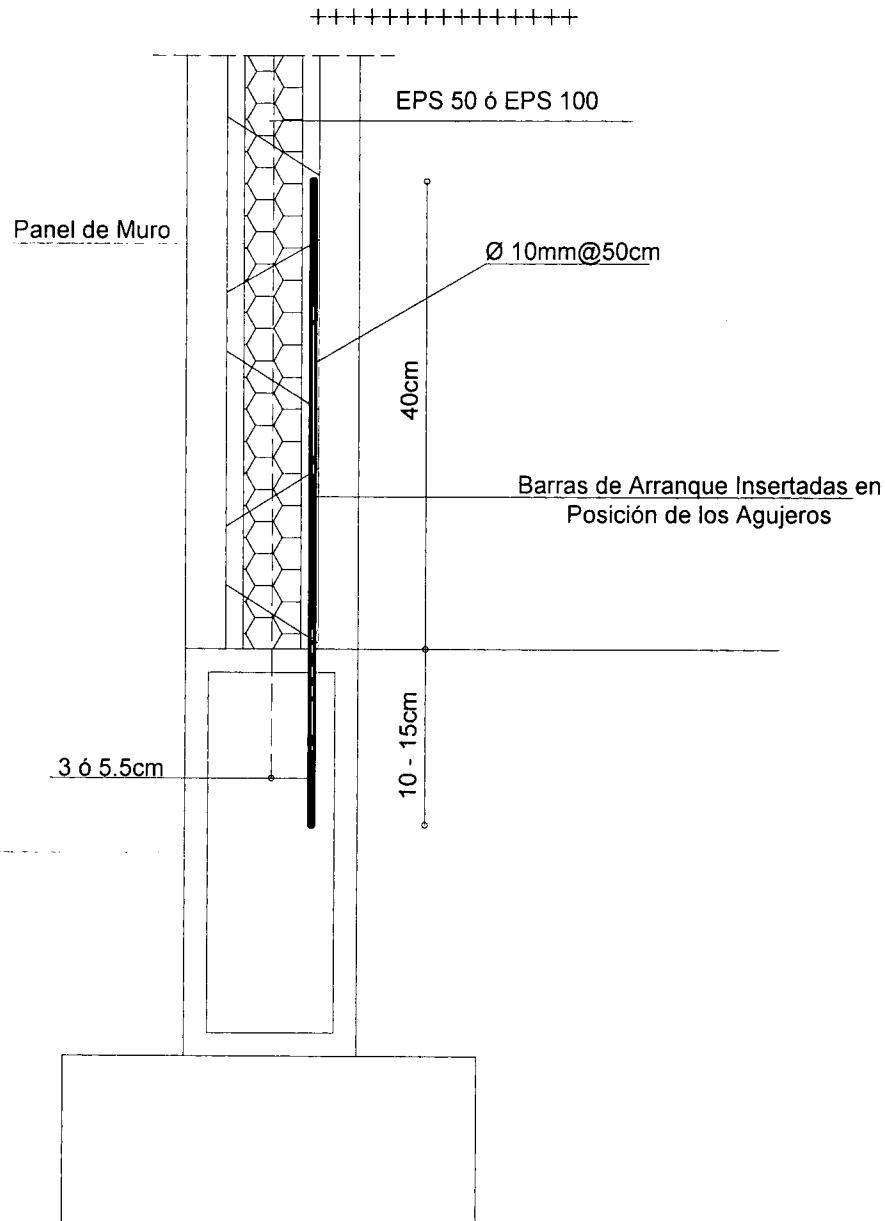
Conexión entre la losa de cimentación y el muro exterior mediante las barras de arranque (cimentación corrida).
